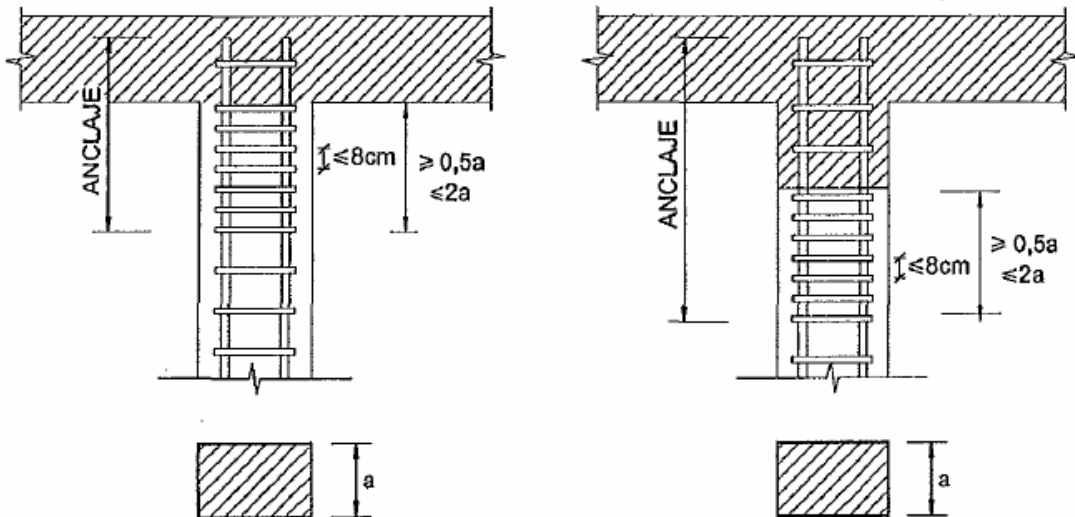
Refuerzo de la armadura de estribos en la zona de anclaje de la armadura longitudinal
